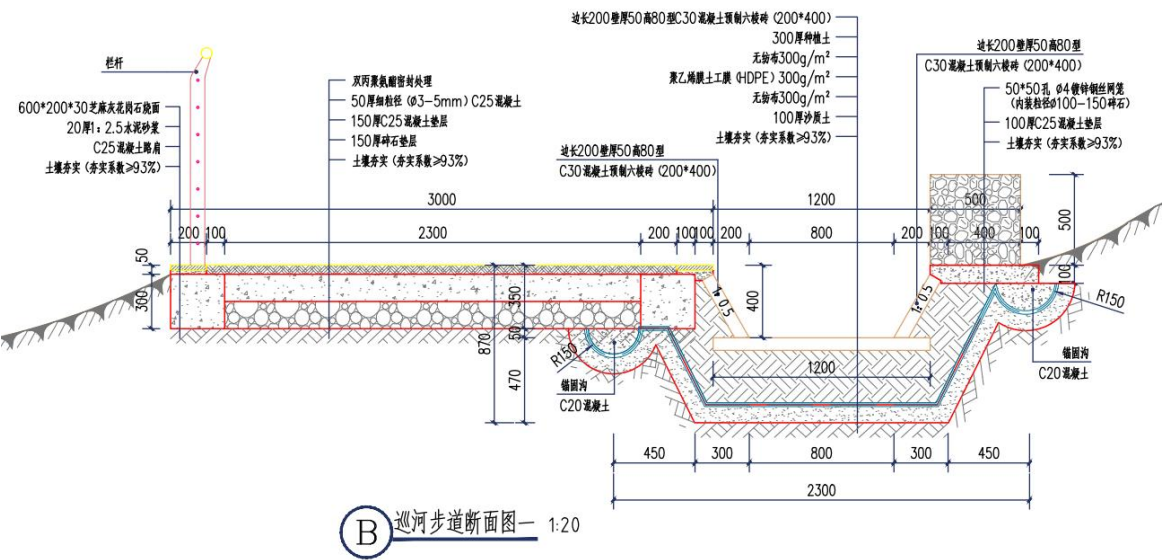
巡河步道（含生态截水沟及石笼挡墙）断面示意图
